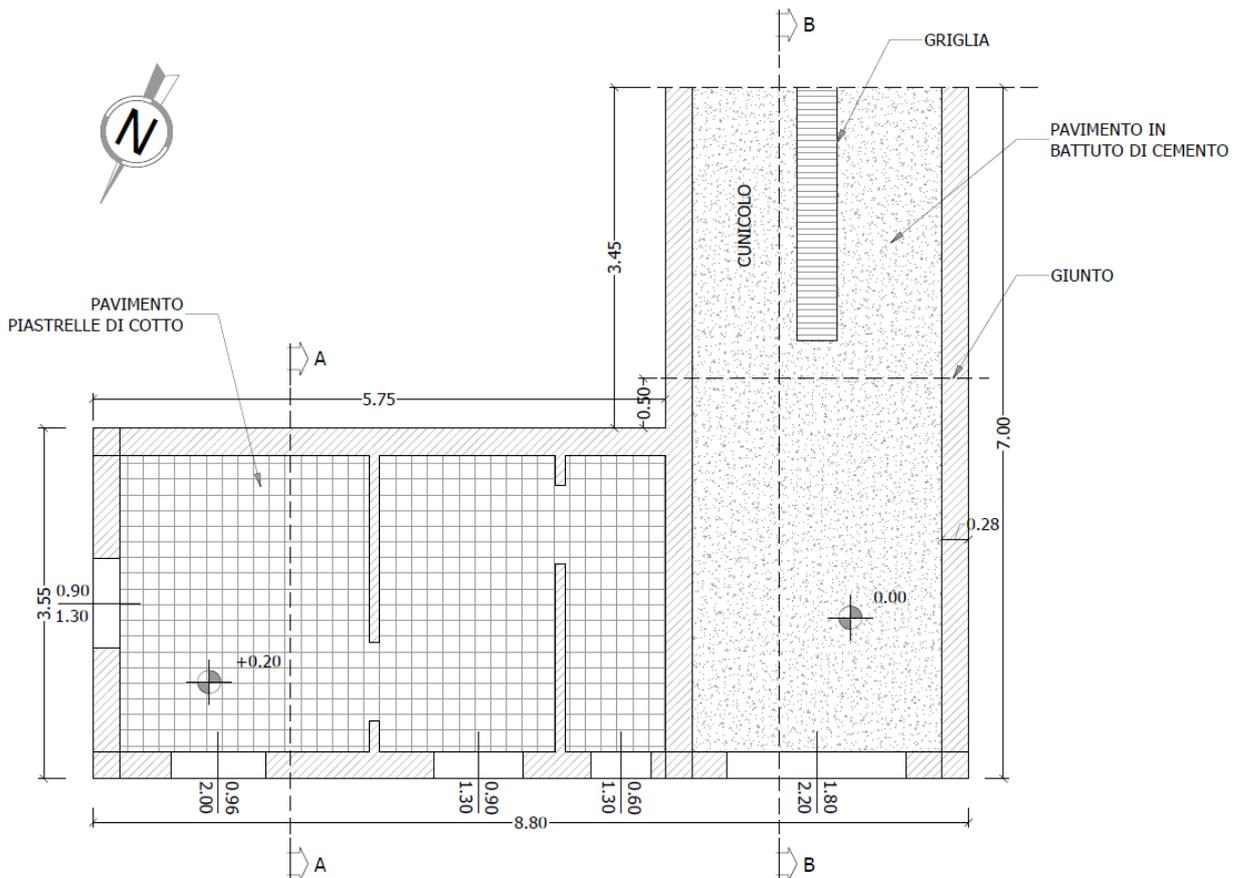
PIANTA EDIFICIO DI RICOVERO GUARDIANI
